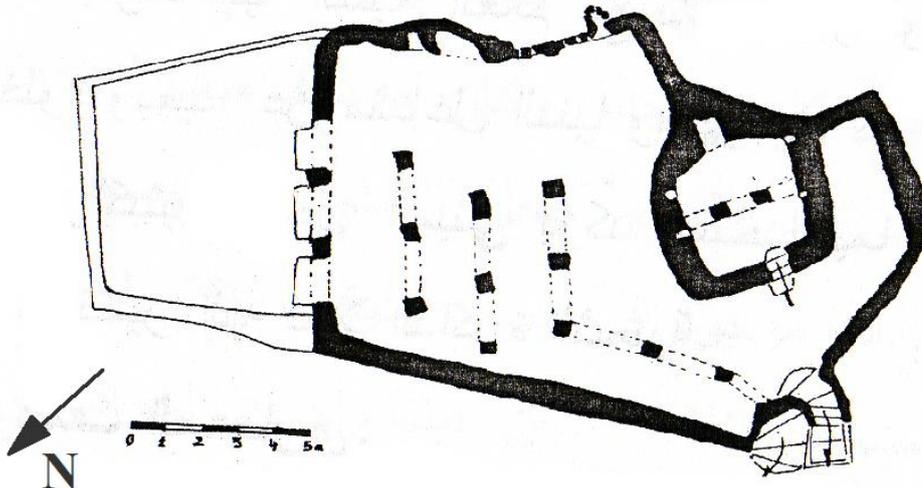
6. Plan du Mausolée Sidi Brahim_Atteuf. (Source : OPVM)
